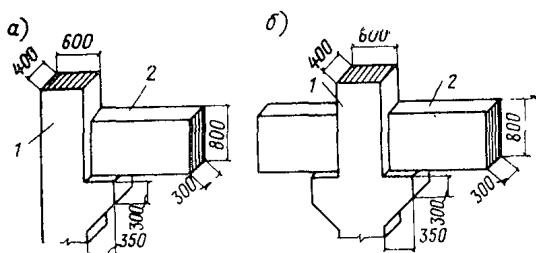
Крайний (а) и средний (б) узлы рамы с опиранием ригелей на железобетонные консоли колонн
